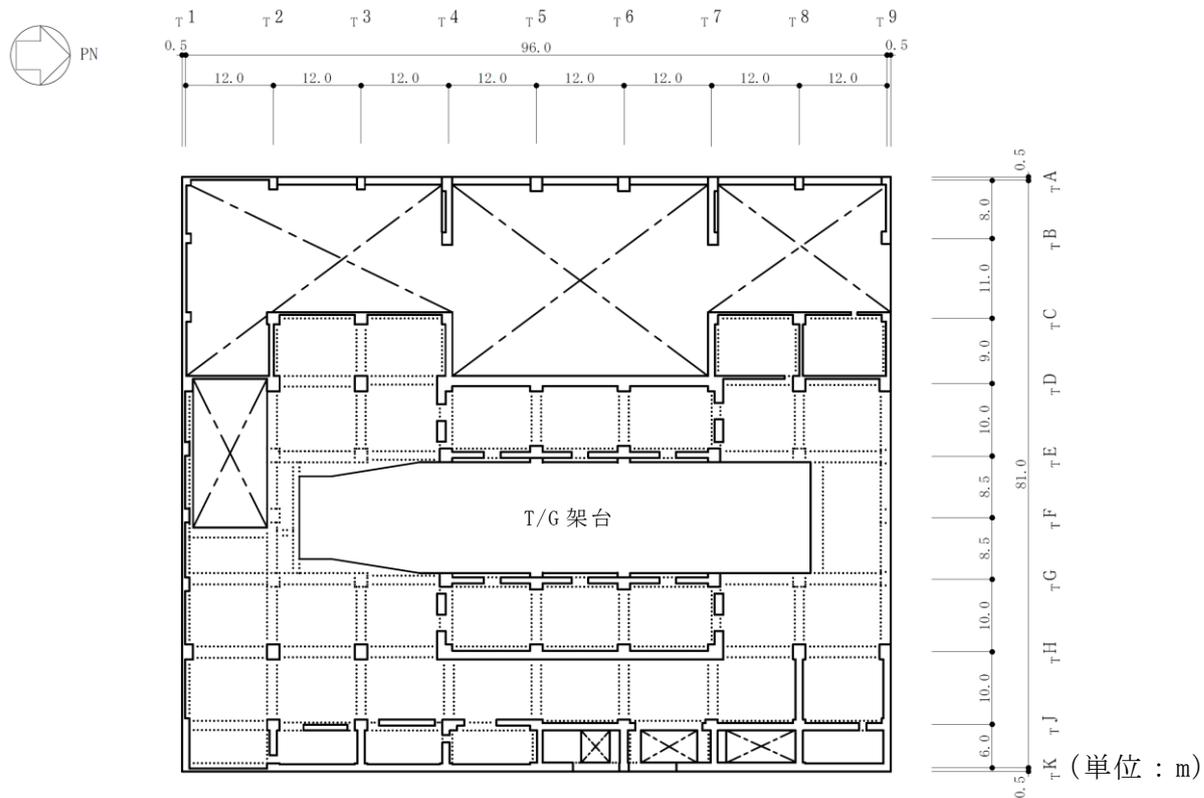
タービン建屋の概略平面図 (2F, T.M.S.L. 20.4m) (4/6)
